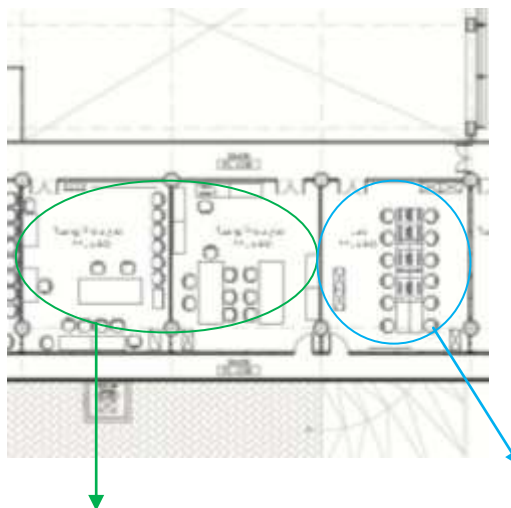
Denah Ruang Terpilih 1 yaitu Area Showroom
